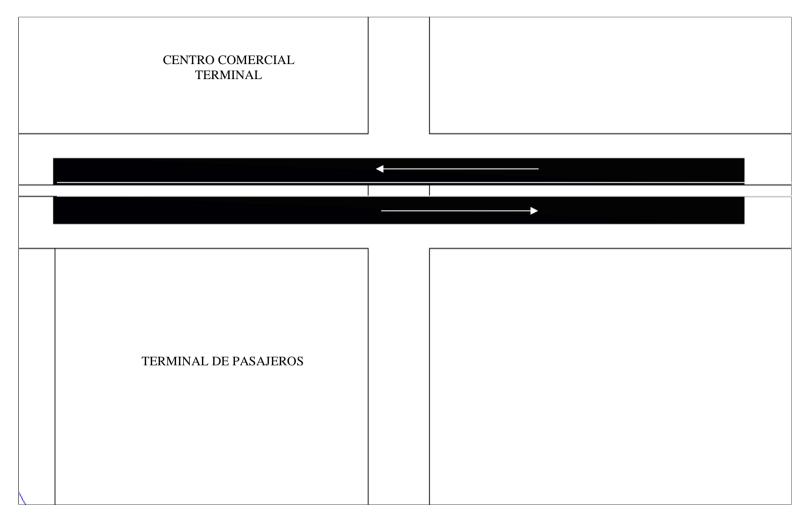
Vista en planta de la propuesta de elevado en el Terminal de Pasajeros.
